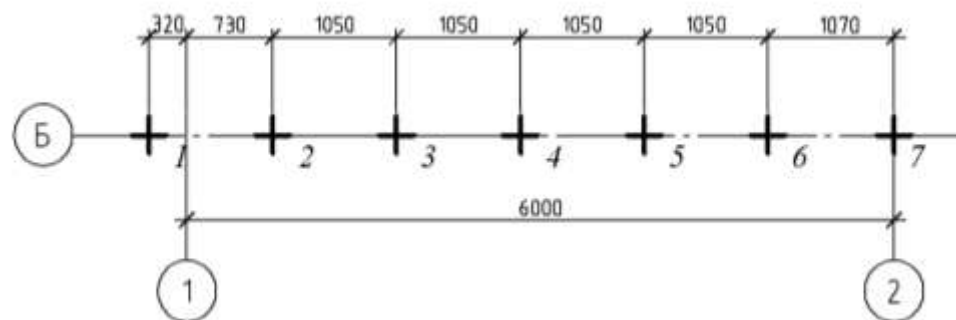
Пример оформления плана свай ленточного свайного фундамента
